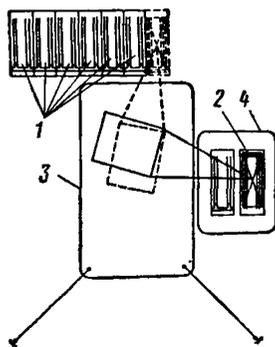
Схема монтажа причальной набережной из уголковых блоков с внутренним анкером
